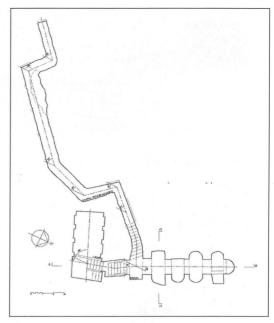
C/ Cristo de Rivas n^{α} 2. Planta general de estructuras subterráneas.
